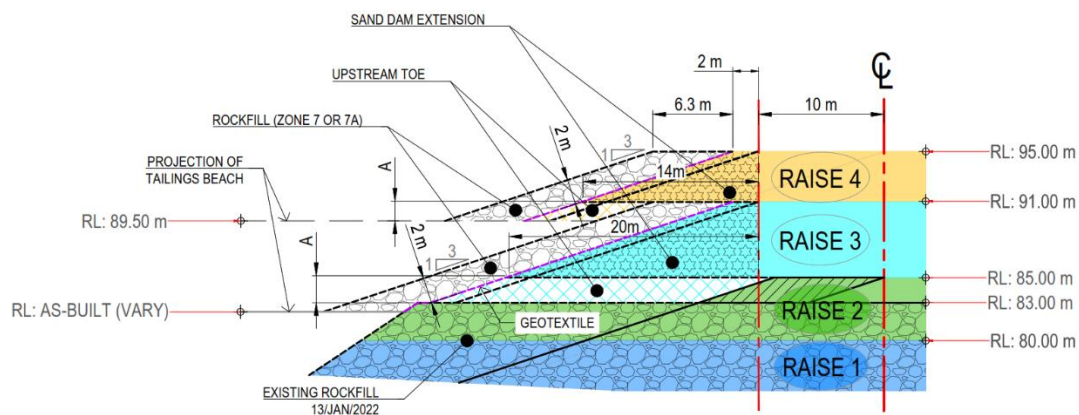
Protección facial aguas arriba en las celdas 12 y 13 de la presa este (1824-363-CI-DRG-T0136)
